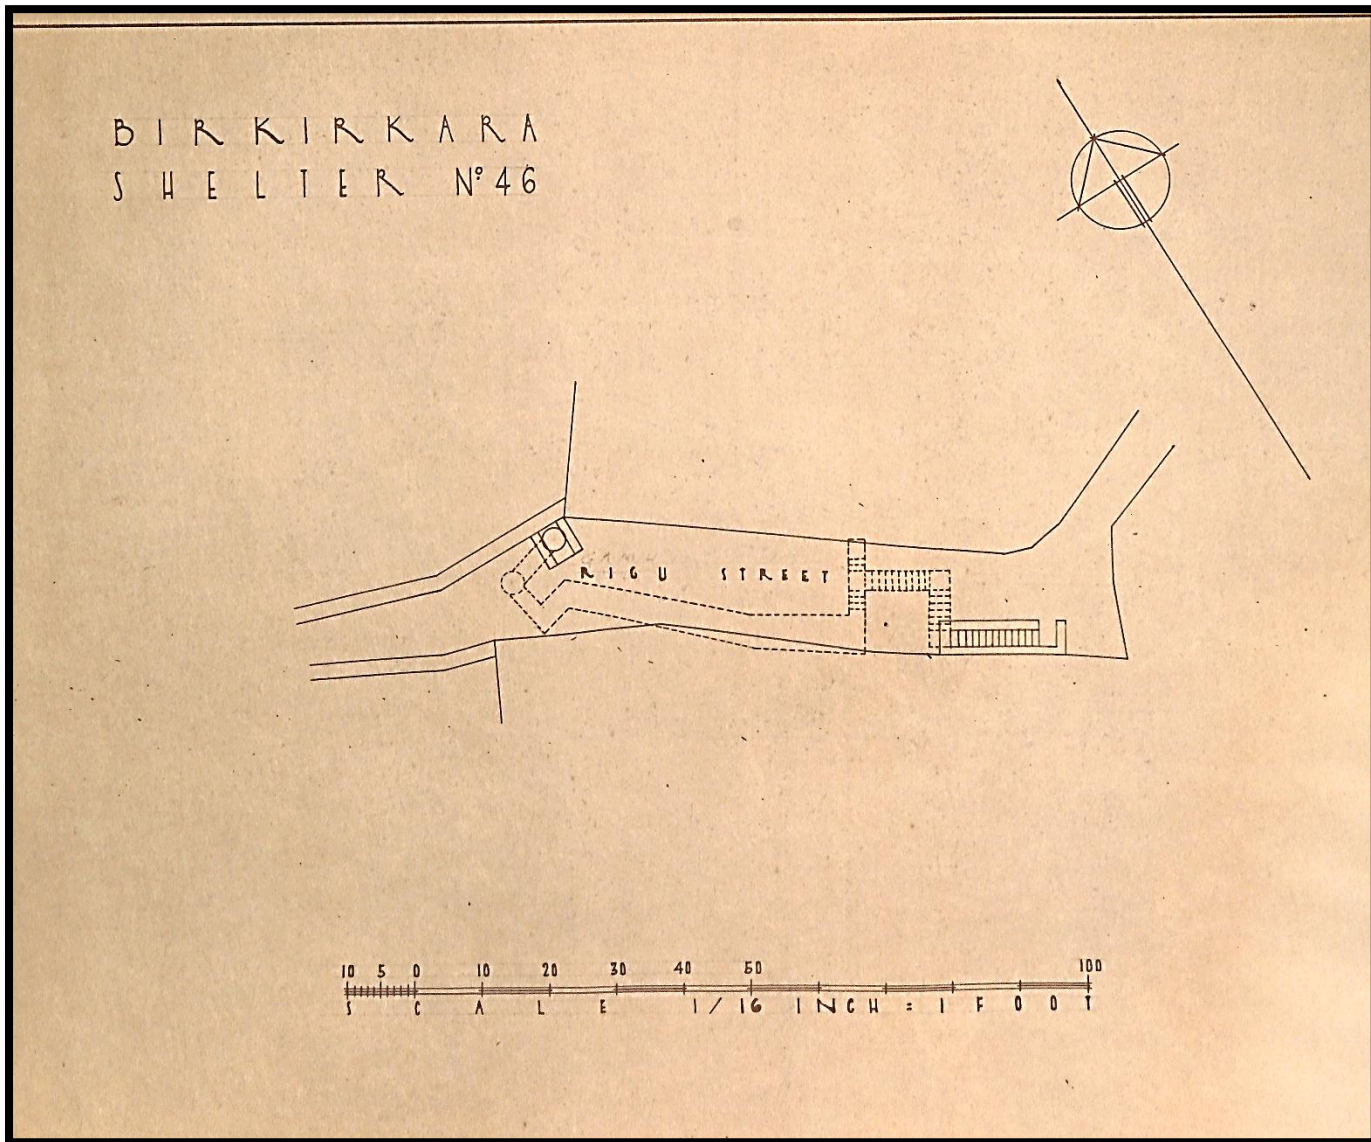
Planta do Abrigo nº46 "Rigu Street"
